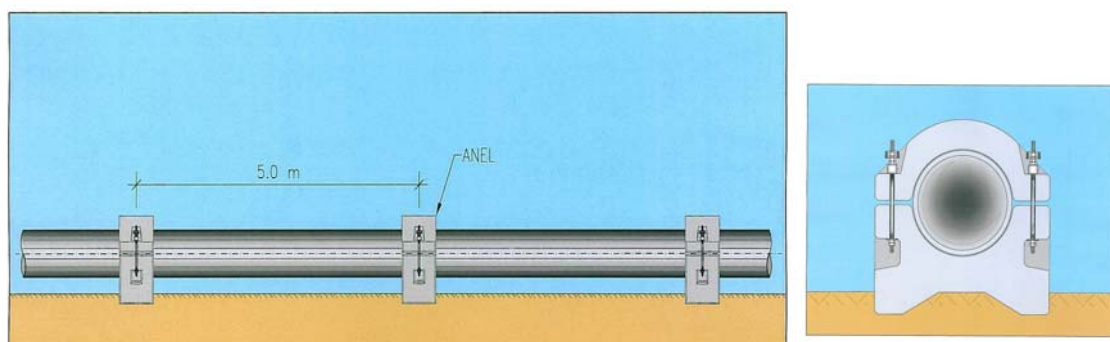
Troço apoiado. Perfis longitudinal e transversal tipo
